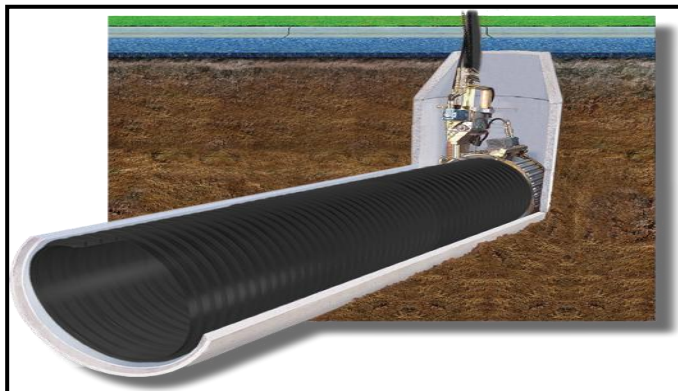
Colocación de las camisas (Pipeliners, 2011)
